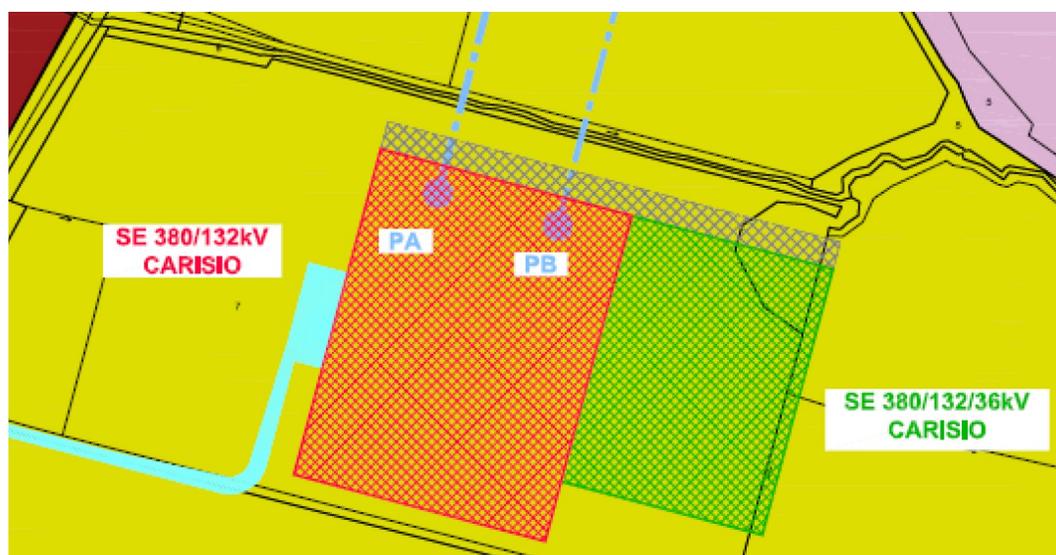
PLANIMETRIA CATASTALE CON DISTANZE DI PRIMA APPROSSIMAZIONE
